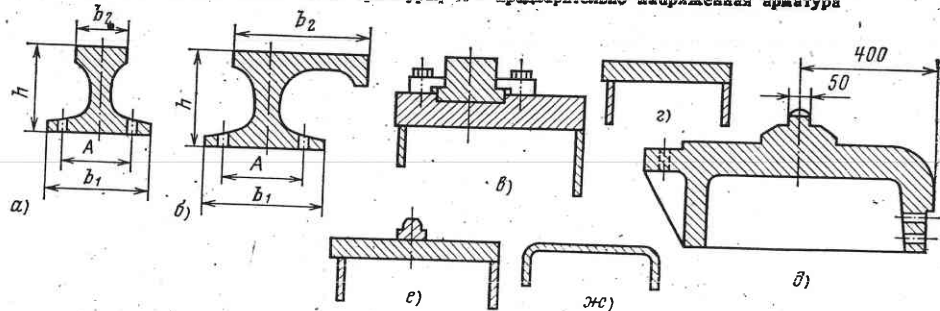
Типы рабочих путей колесных и скользящих затворов: а — литой рельс без консоли; б — литой рельс с консолью; в — путь со съемным рельсом; г — путь плитного типа; д — литой путь с наплавкой рабочей поверхности скользящего нержавеющей стали; е — сварной путь с рельсом из нержавеющей стали; ж — путь из тяжелого профиля (для затворов с опорами из деревянных брусков)
